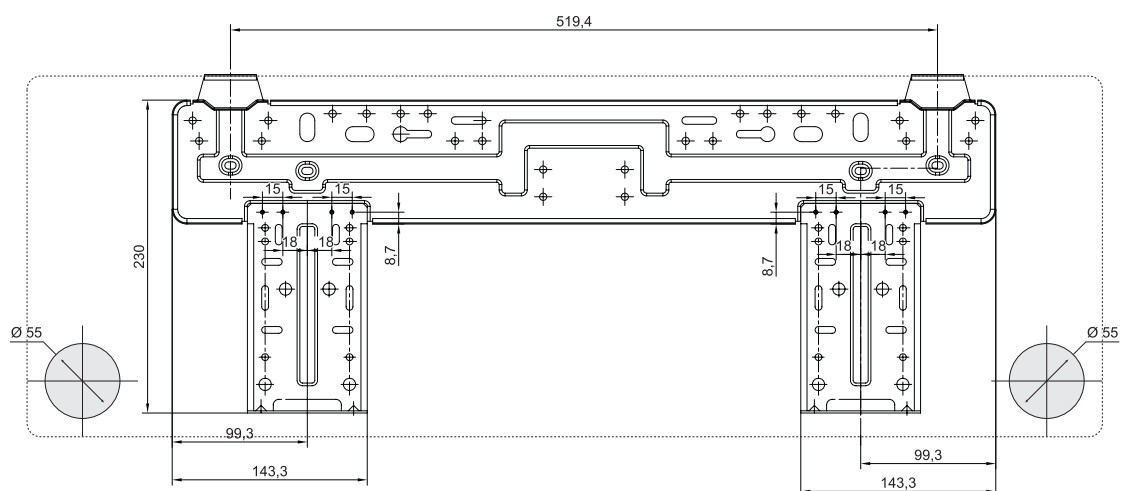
Placa de montagem para VAI 6-025 WMNI.
